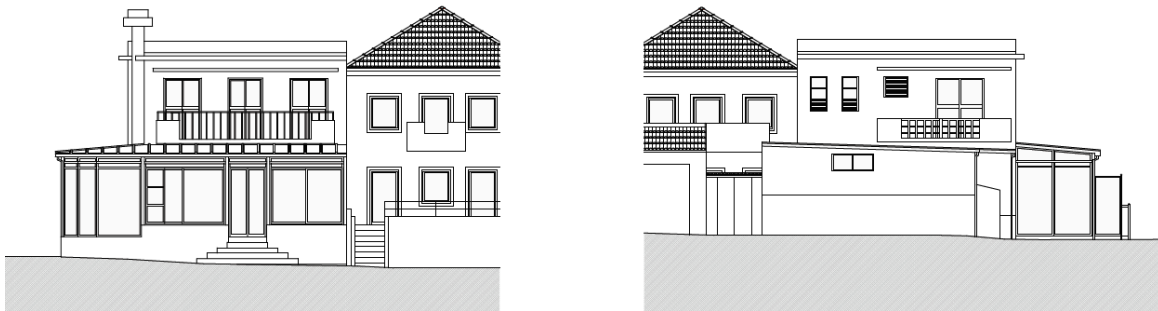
E 48 - EXISTENTE | ALÇADO SUL E NORTE | S/ESCALA
